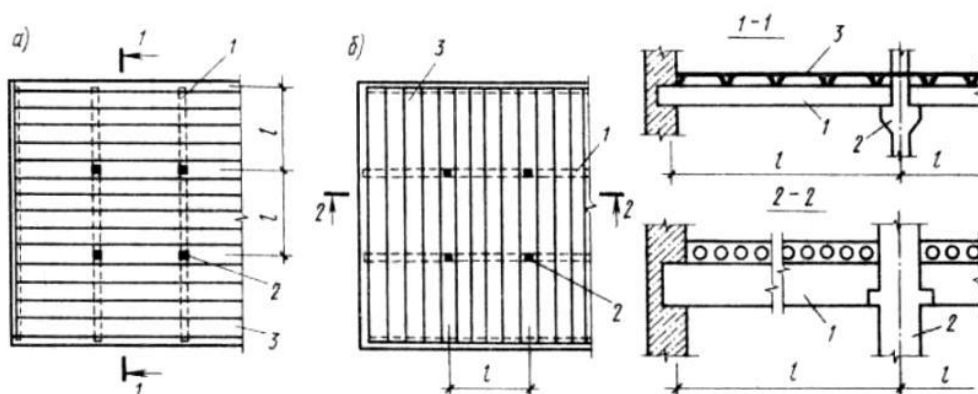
Направление ригелей поперек (а) и вдоль (б) здания в сборном балочном перекрытии
